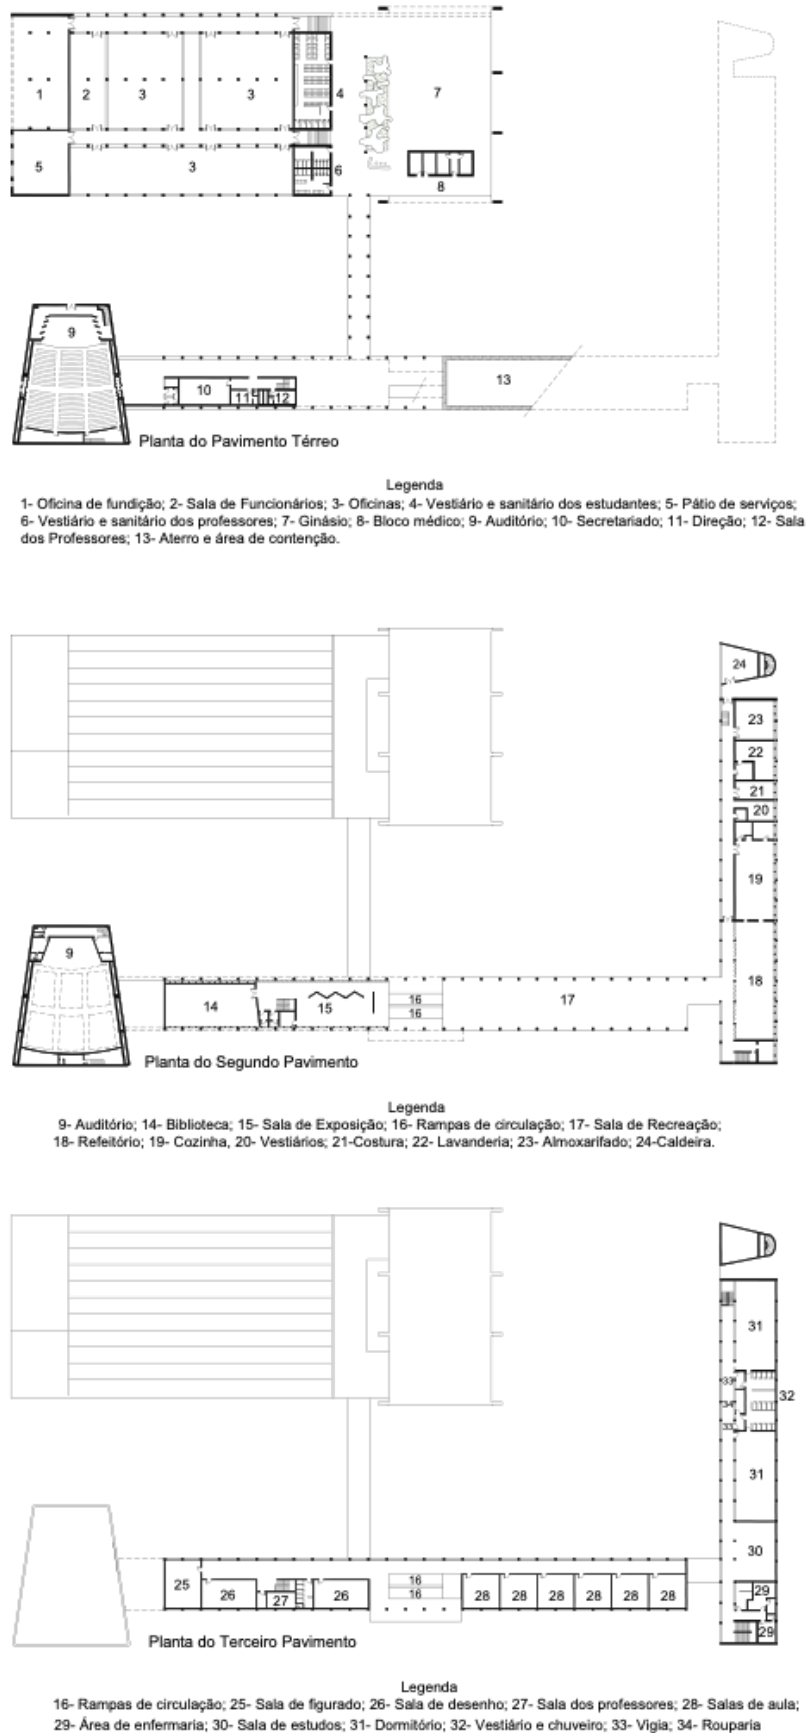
Plantas dos pavimentos da Escola Industrial de Teresina (1952). Fonte: Redesenho de Amanda Bianco Mitre (2019), utilizando como referência plantas presentes na revista *L'architecture D'aujourd'hui* (1952) (pavimento térreo e segundo pavimento) e *Arquitetura e Engenharia* (1952) (terceiro pavimento).
